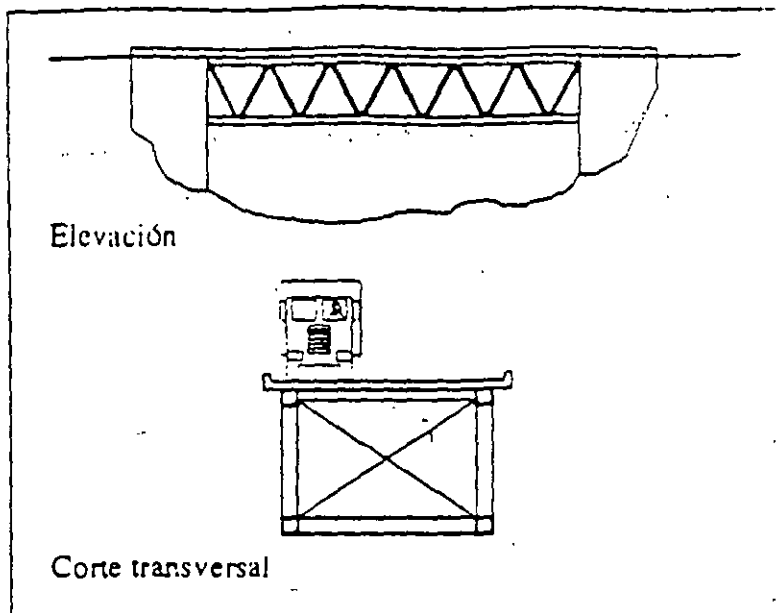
Sección transversal, tipo 41, Armadura a Paso Superior
